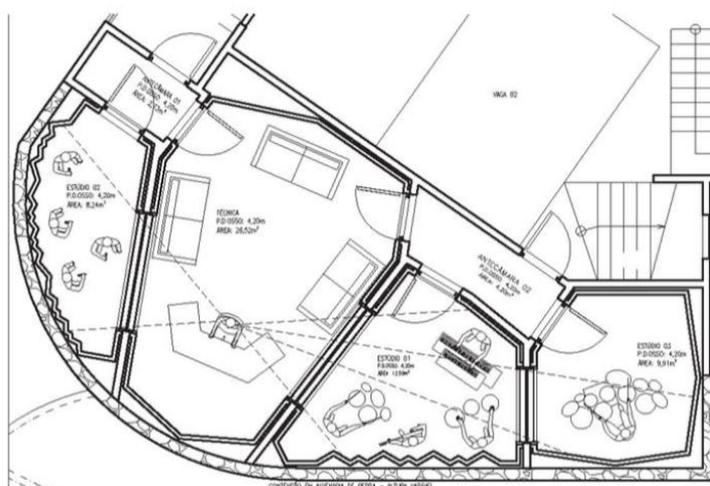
Planta baixa de estúdio com sala de controle, e três salas de gravação.
